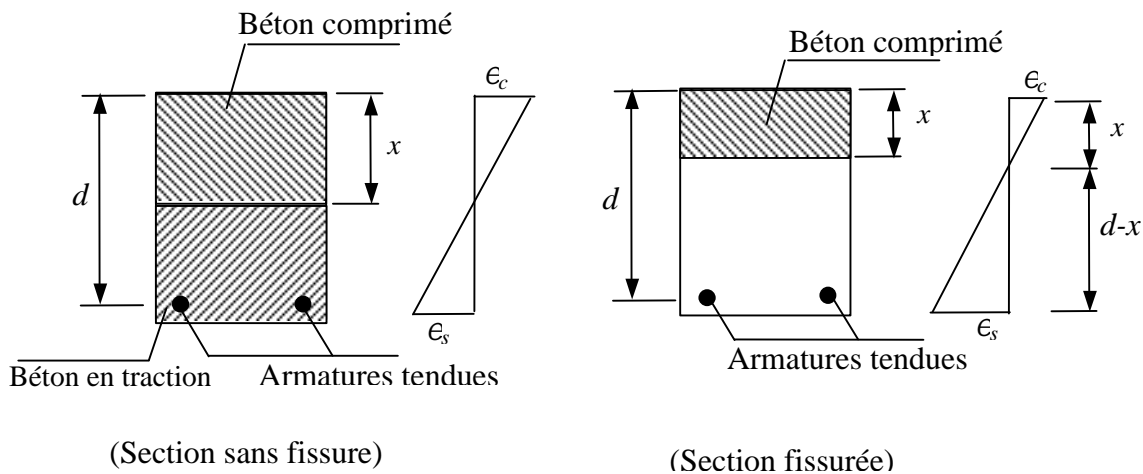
Schéma de la section pendant la procédure de pré-fissuration
